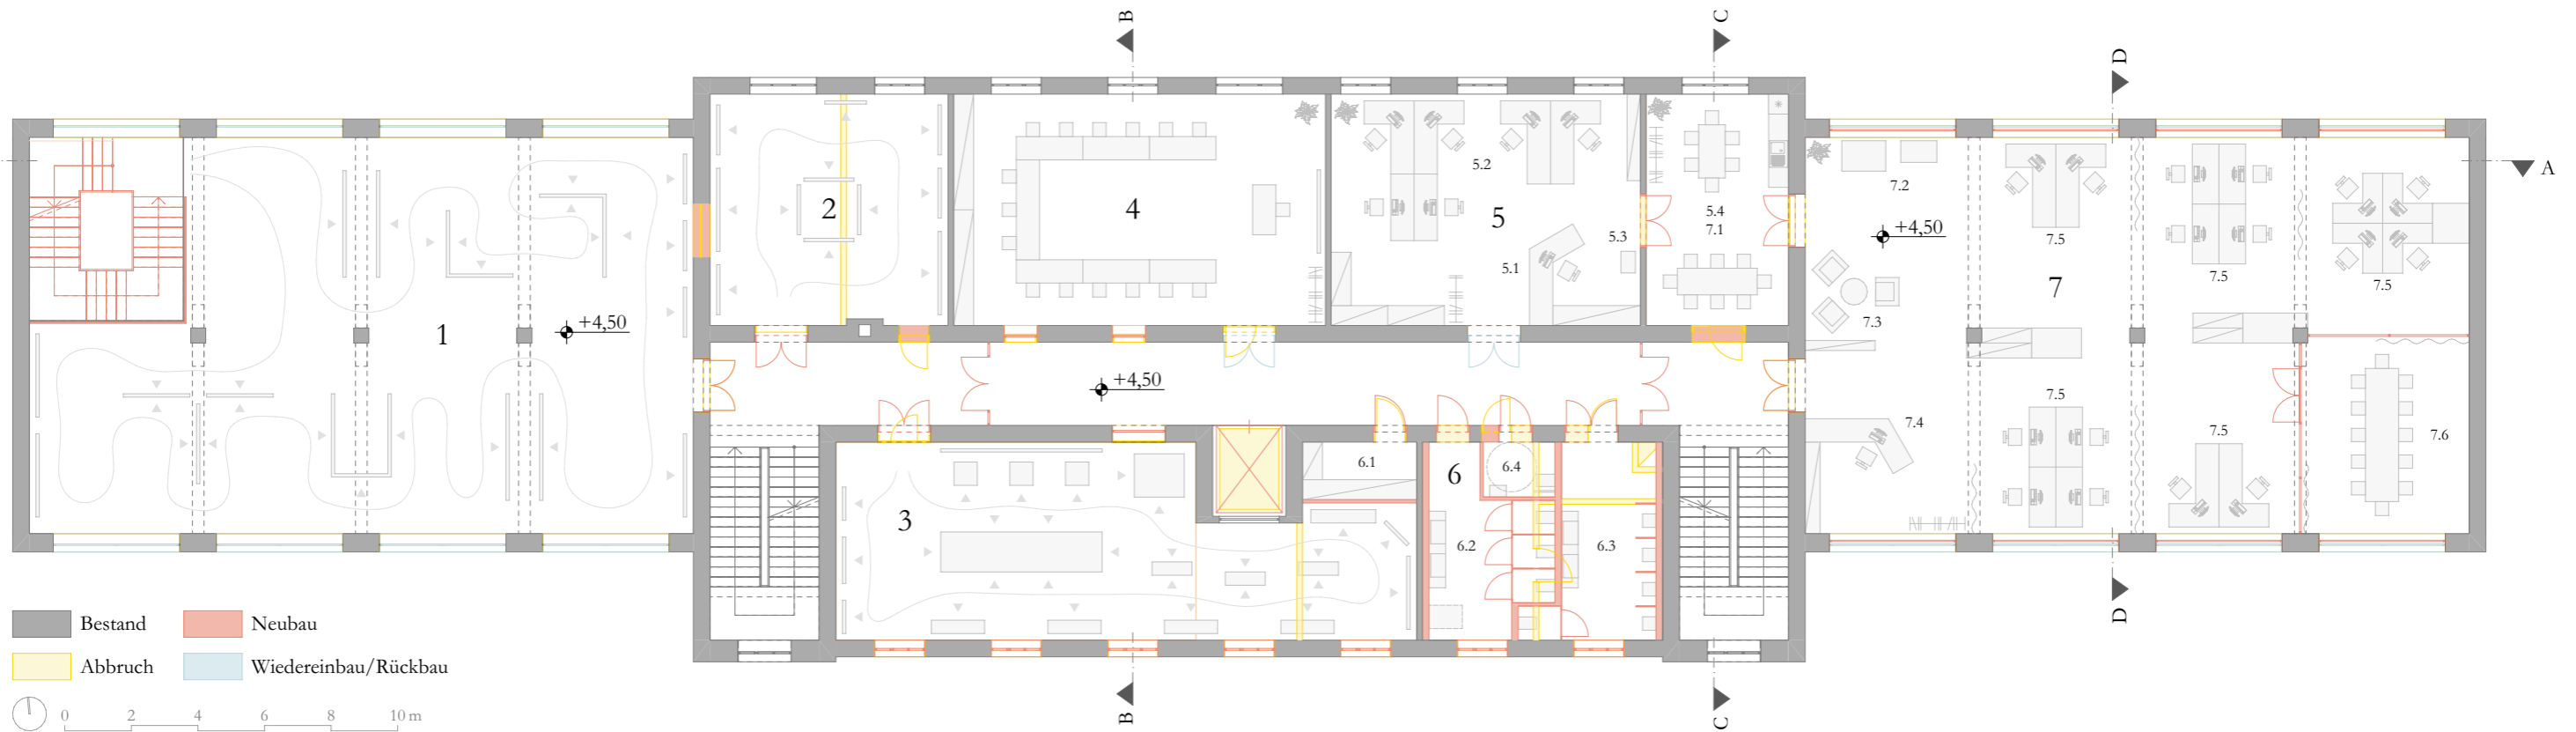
Grundriss Obergeschoss (Konzept Gesamt) M 1:200
